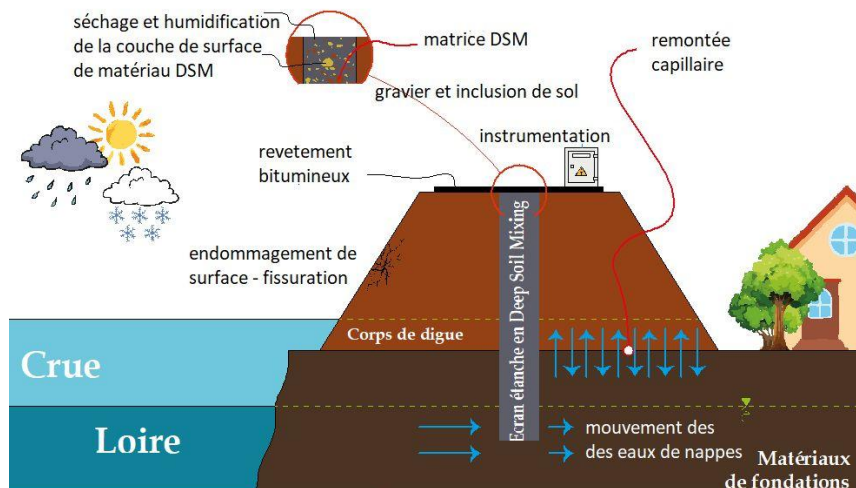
Sollicitation de paroi d'étanchéification en matériau Deep Soil Mixing (DSM).
